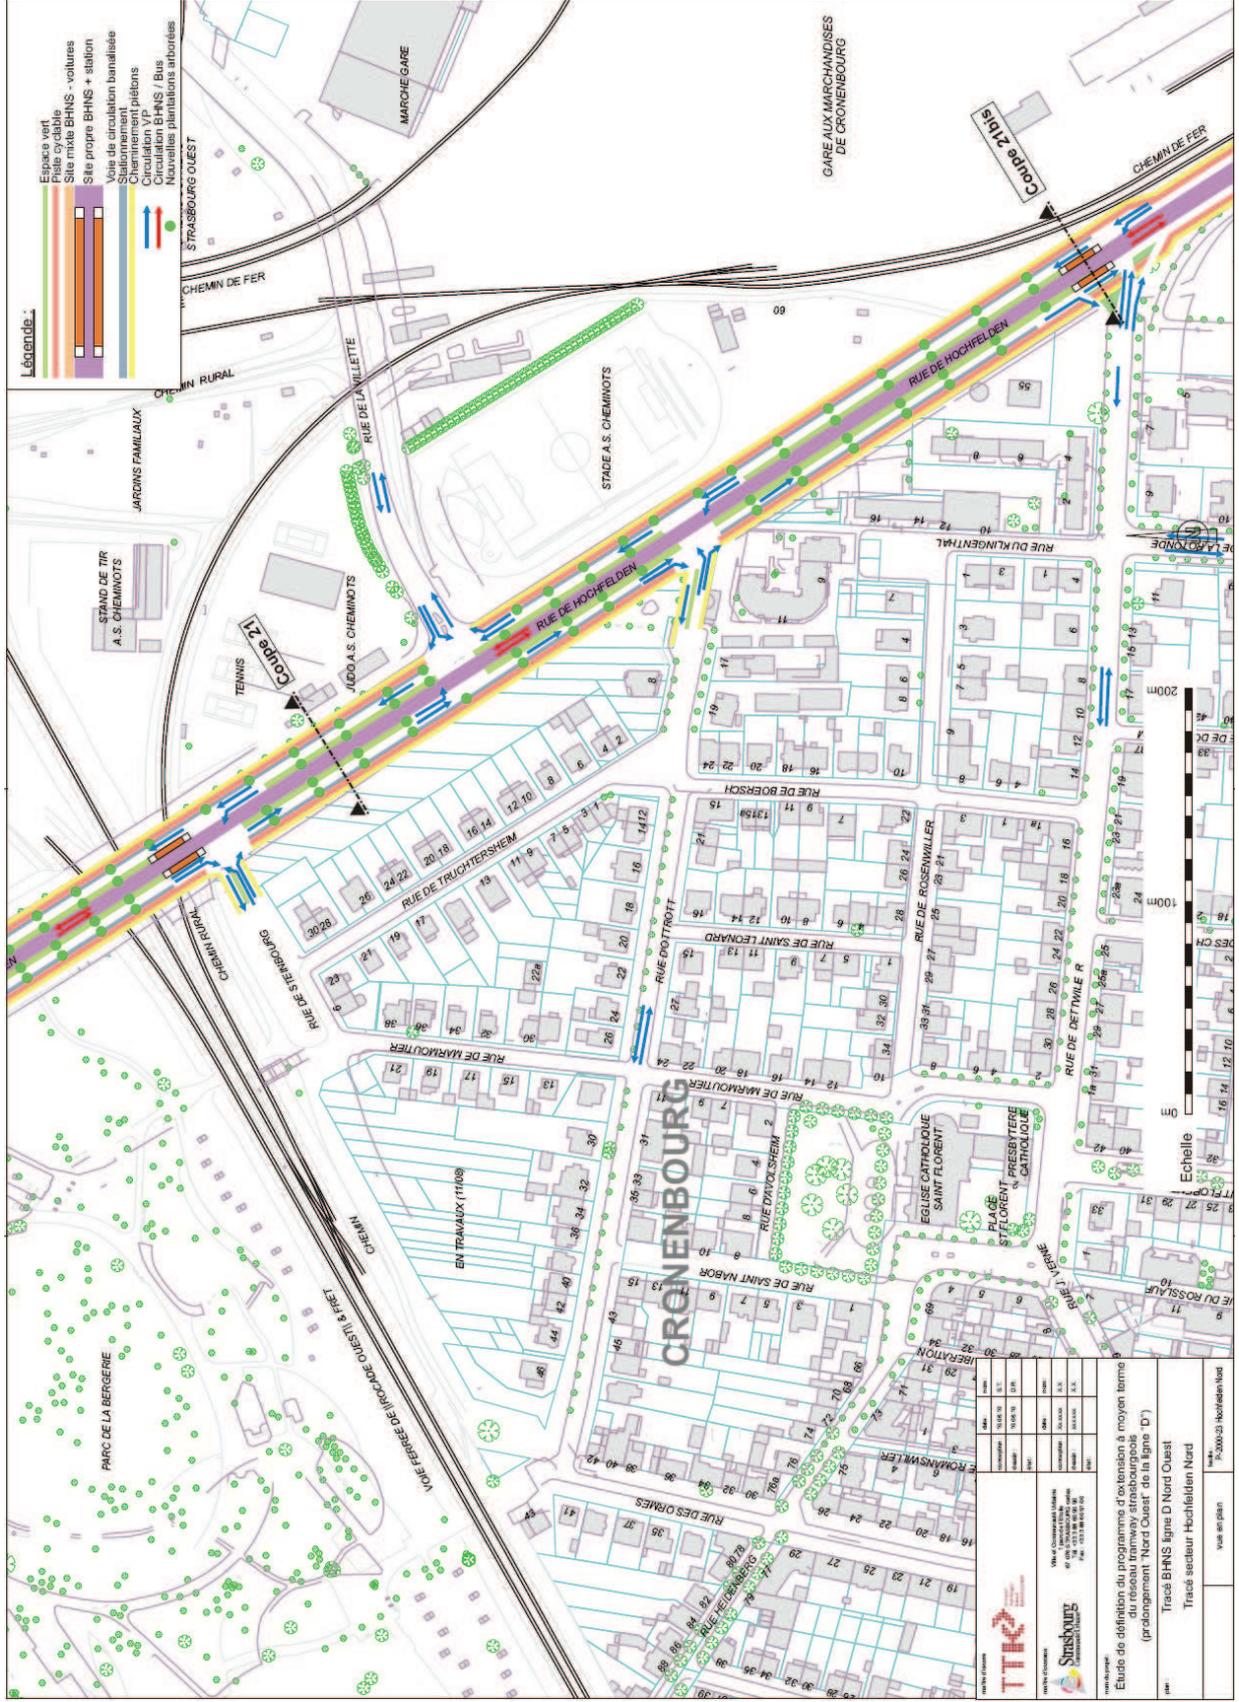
Plan d'insertion du secteur "Hochfelden Nord" (échelle 1/2500 (moyenne))
